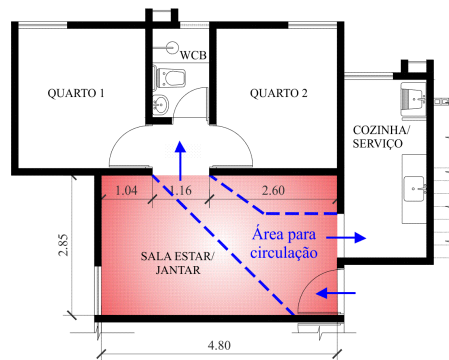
Planta Baixa Pav. Tipo: Setor Social do Residencial Praias Belas (sem escala)
